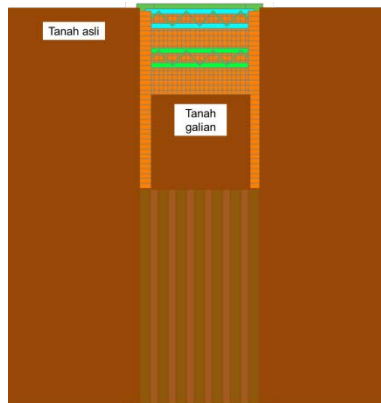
Pemasangan *supported beam* elv. -4.00 hingga -5.50
